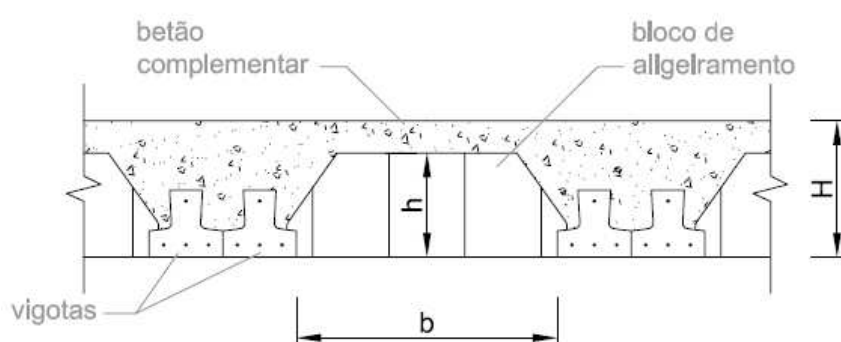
Esquema da solução laje aligeirada de vigotas pré-esforçadas S6 – corte transversal (vigotas duplas).
